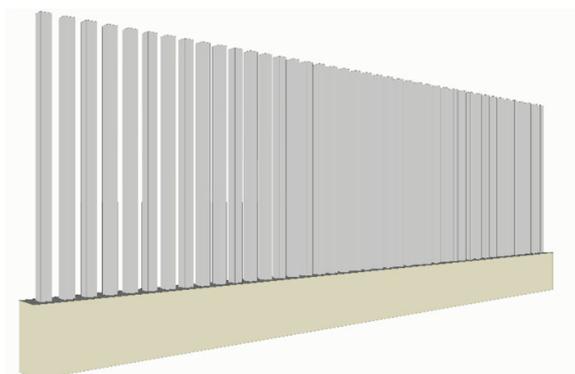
Vista prospettica della recinzione della SSE utente di trasformazione
